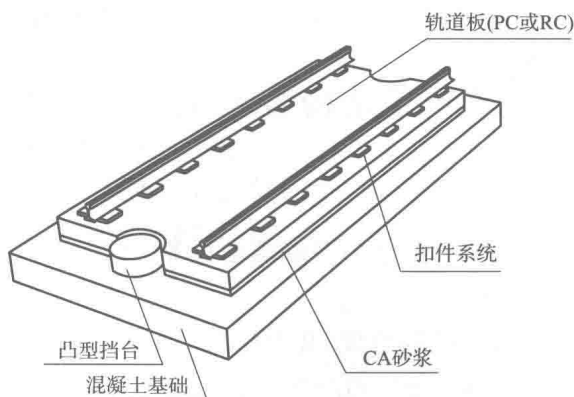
普通 A 型板式轨道(钢筋混凝土、预应力混凝土轨道板)
